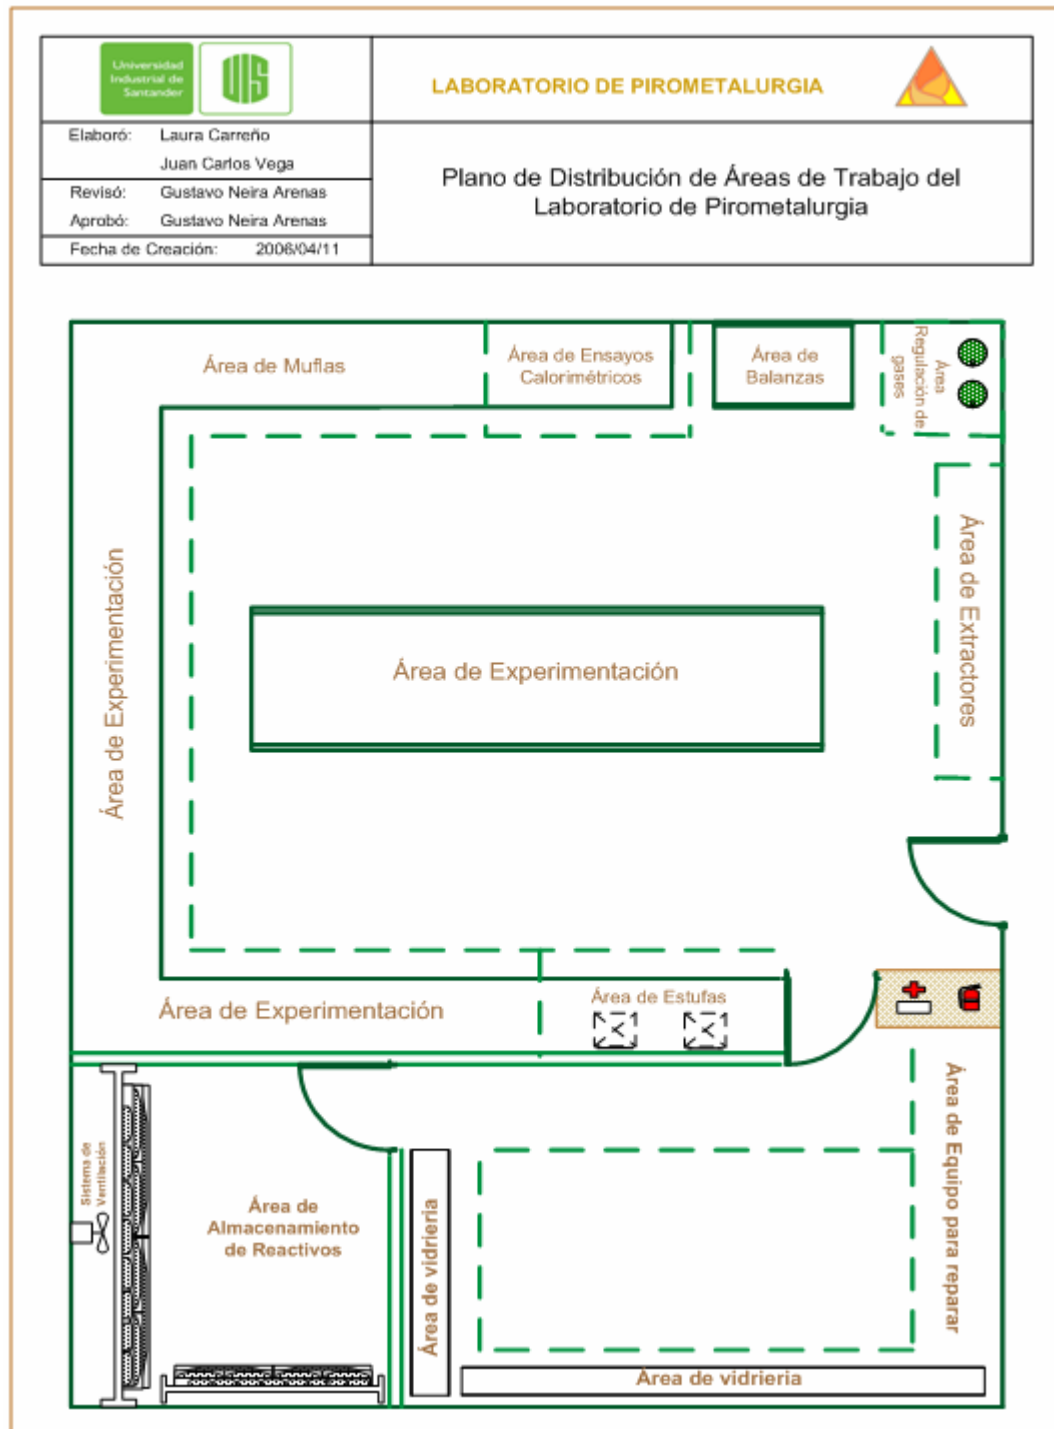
Plano Propuesta de Laboratorio de Pirometalurgia. Edificio Planta de Aceros.
